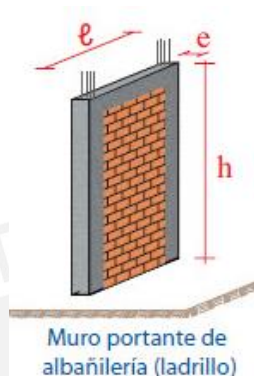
Muro de albañilería confinada (Adaptado de Aceros Arequipa, 2011)
